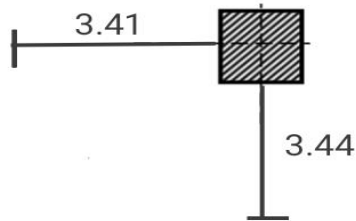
Surface revenant au poteau d'angle (poteau N15)
